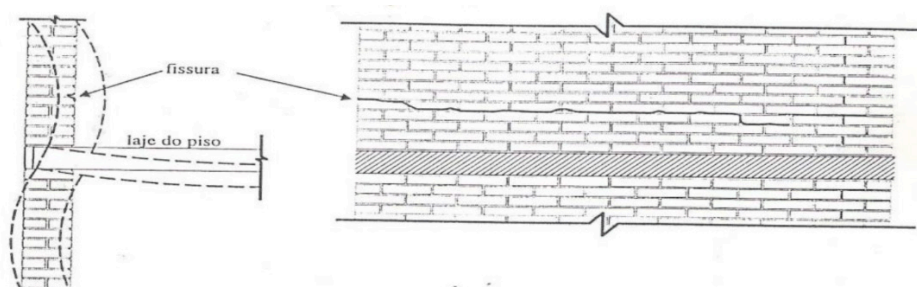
Configuração das trincas na alvenaria devido a deformação excessiva da laje. (Silva e Jonov)
